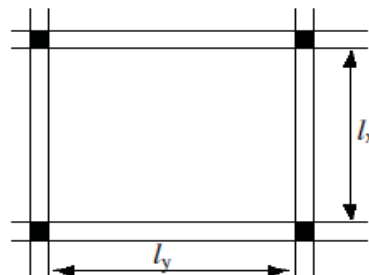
Dimensions d'un panneau de dalle pleine.
